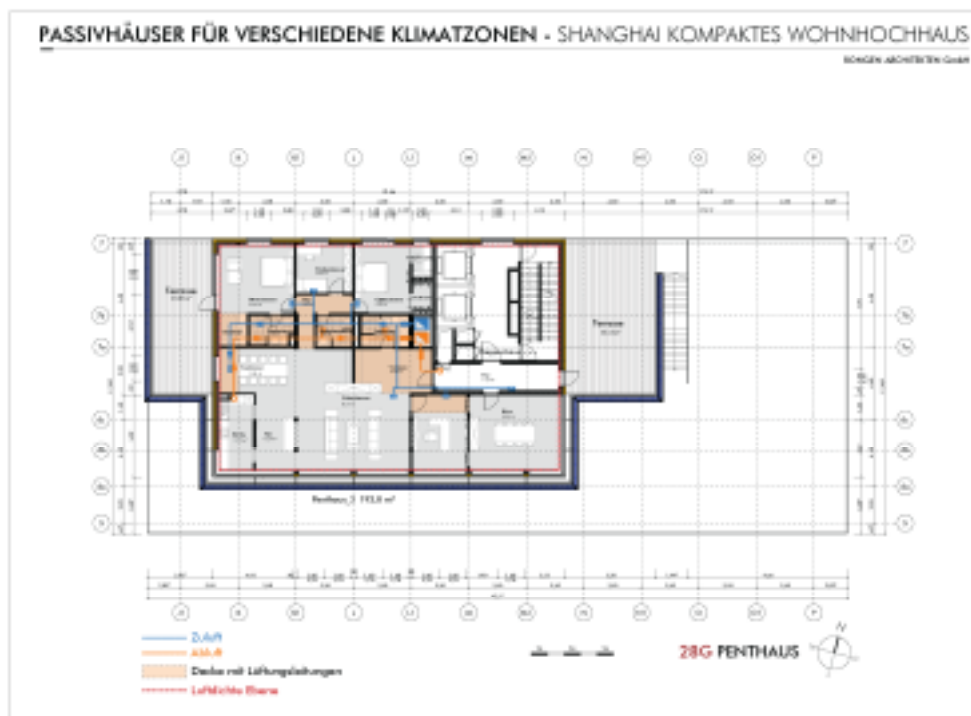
Wohnhochhaus Shanghai – Grundriss Ebene +29 – oberste Wohnebene
